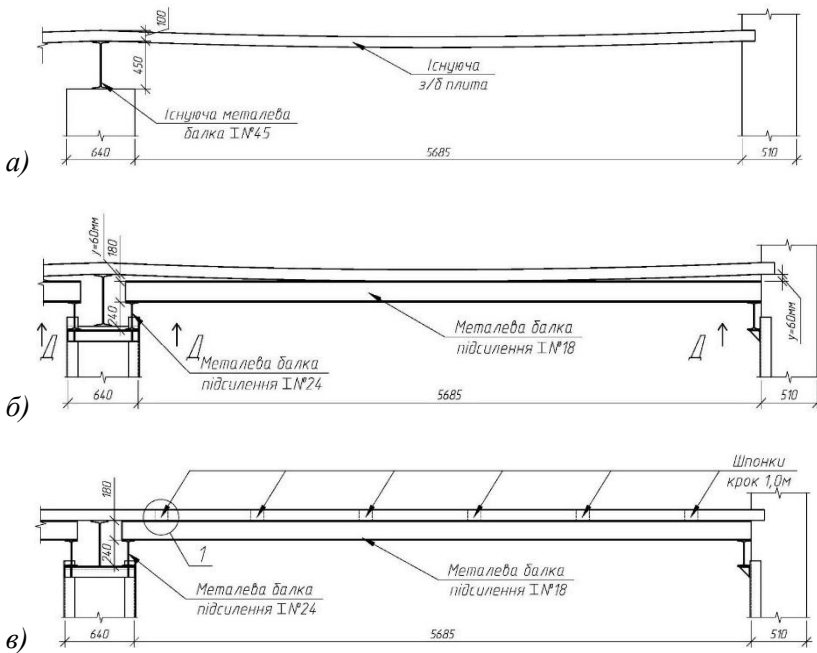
Схеми підсилення залізобетонного перекриття: а) – вигляд залізобетонного перекриття до підсилення; б) – влаштування підсилення сталевими балками; в) – забезпечення сумісної роботи залізобетонної плити і сталеві балки
